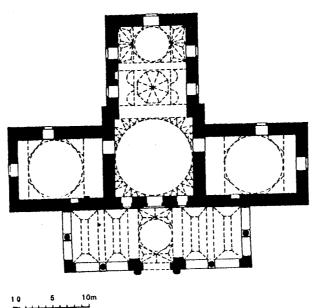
مسقط أفقي لجامع حمزة بك في بورصة (اوبروسه) (عن : Wilde) .
